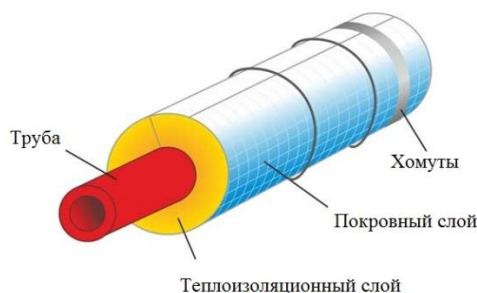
Общая схема конструкции изоляции трубопроводов.
